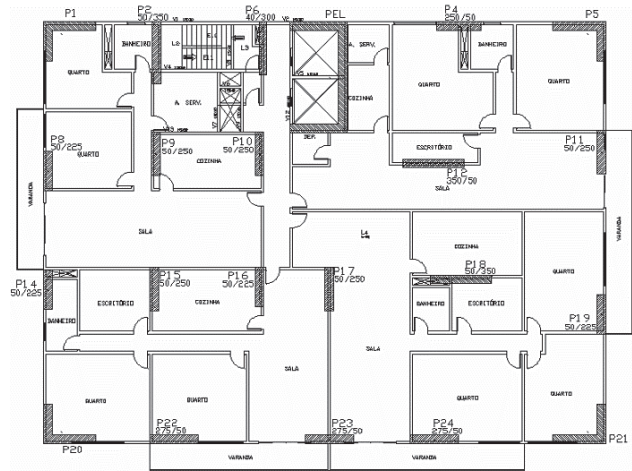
Arquitetura x Estrutura – Pavimento tipo – Laje lisa – Modelo 01/01
